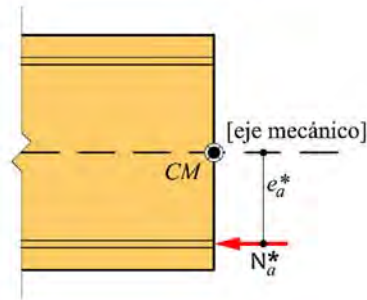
Barra de hormigón pretensado con adherencia. Esfuerzo axial actuante en el tendón con adherencia.
